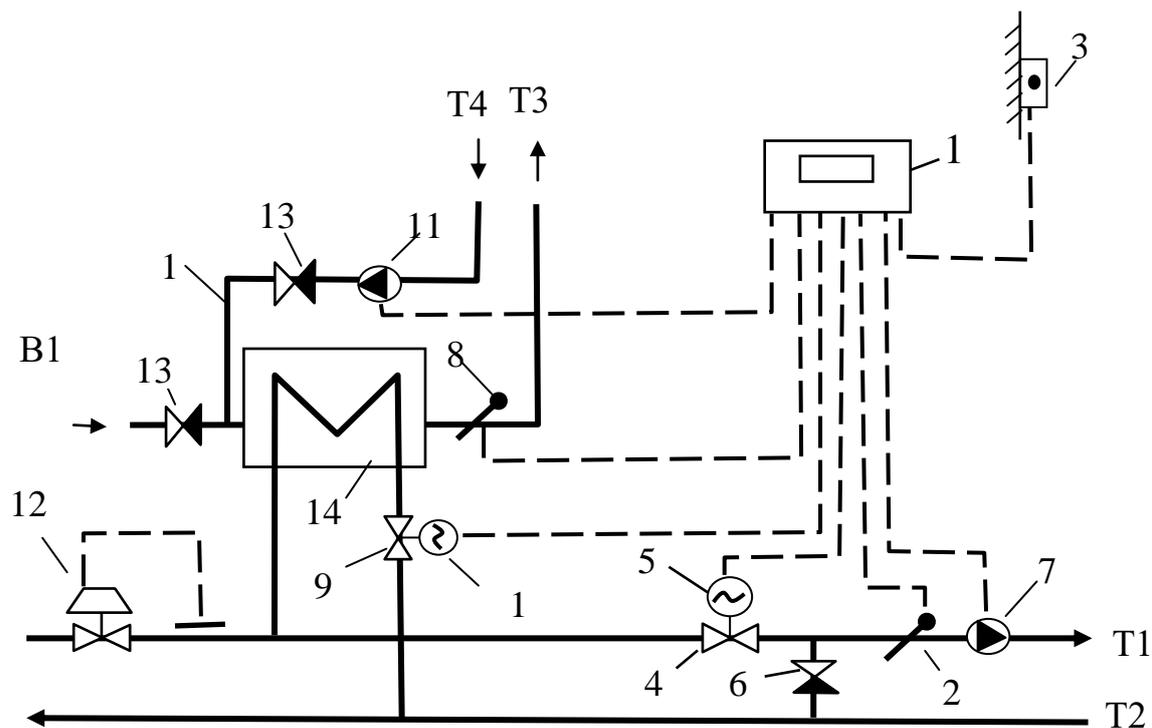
Схема оборудования ИТП (второй вариант реконструкции):
